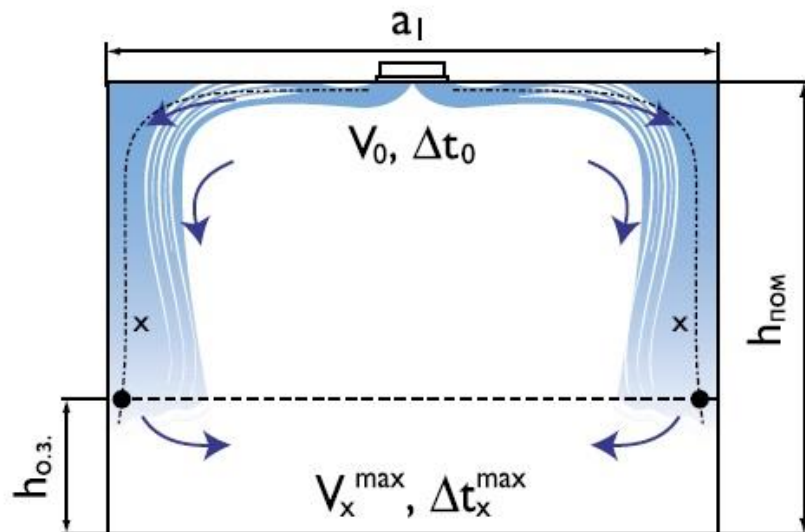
подача воздуха сверху вниз настилающимися на потолок веерными струями по схеме Д
